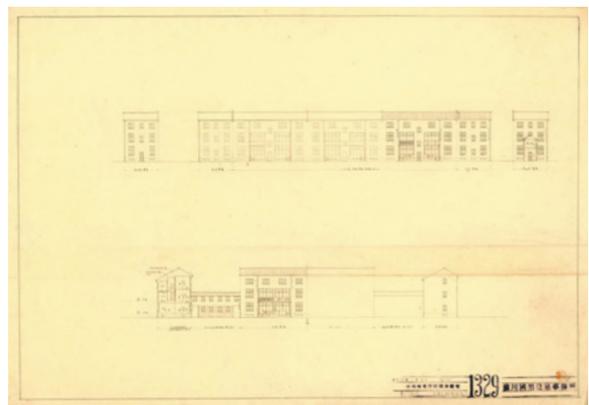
華人住宅 立面図及断面図 其ノ一 [1329]
